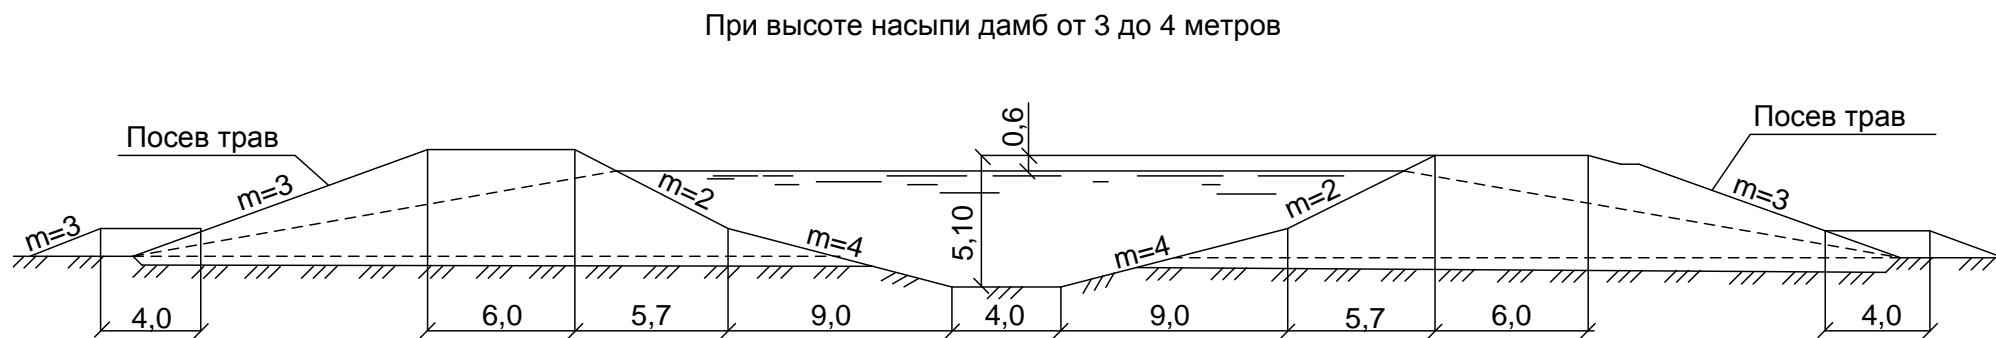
Поперечные сечения ПМК при высоте насыпи дамб от 3 до 4 метров
